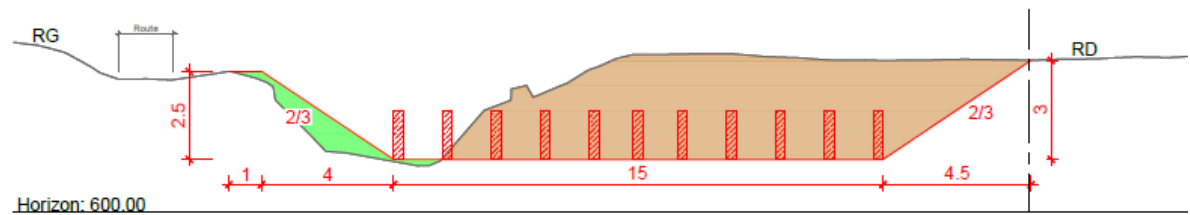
Profil en travers de la variante 2 de plage de dépôts sur l'Ugine – PK 2.776
